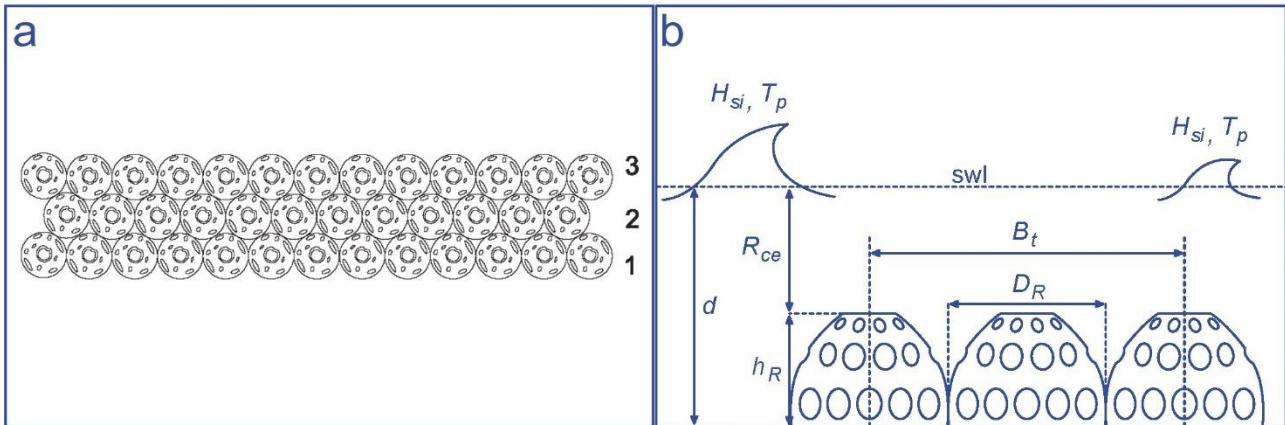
Configurazione ReefBall BS-1e scelta per l'intervento; (a) vista in pianta; (b) vista in sezione con indicazione delle variabili adoperate in caso di elementi posizionati direttamente sul fondale: Hst, altezza dell'onda alle spalle dell'opera; Hsi, altezza dell'onda incidente; Rce, sommergenza della struttura; DR, diametro di base;
